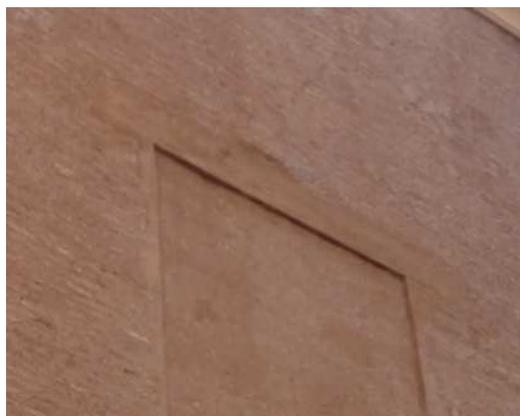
Detalle de muro de ladrillo manual con la junta enrasada. (MARÍN)
